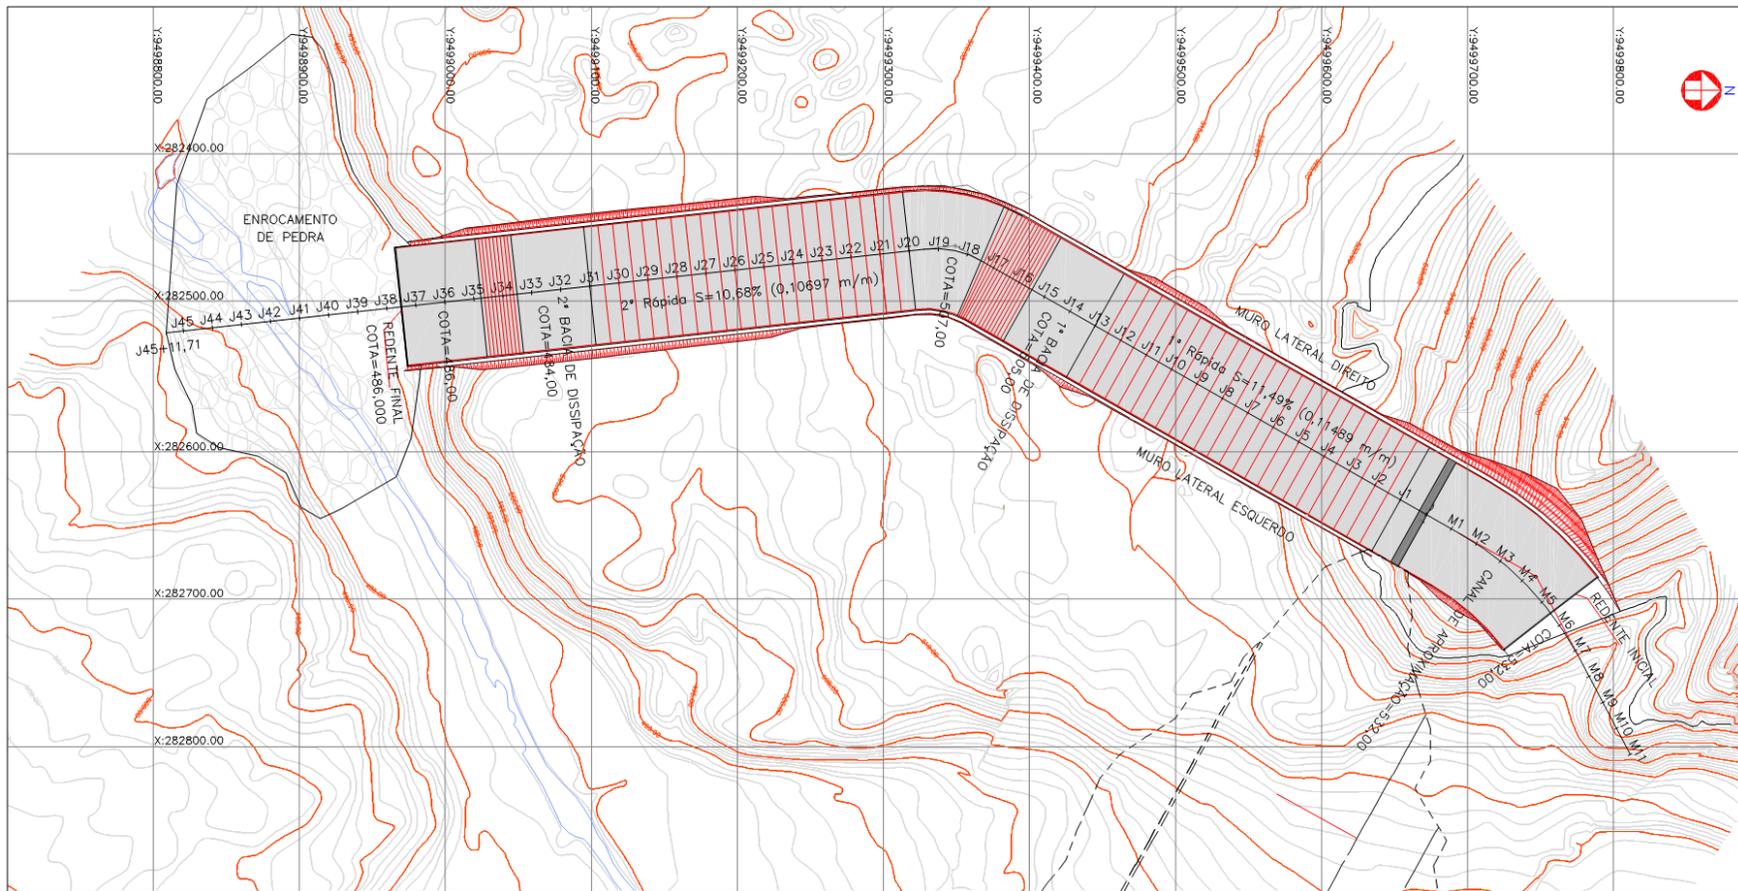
Planta esquemática do sangradouro da Barragem Lontras
